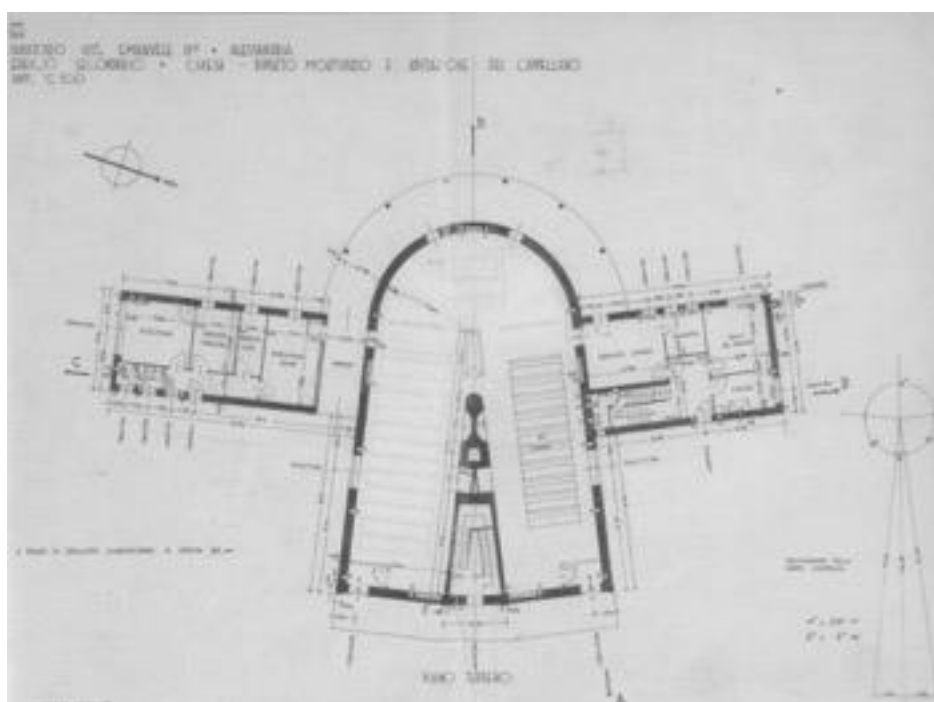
Pianta di progetto, 1934 (da Archivio Gardella, Oleggio – G3.san.V.E.).
